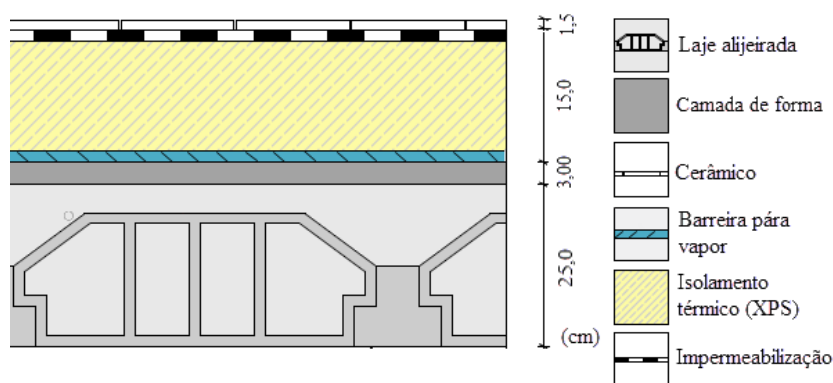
Solução construtiva da laje de cobertura plana – acessível
